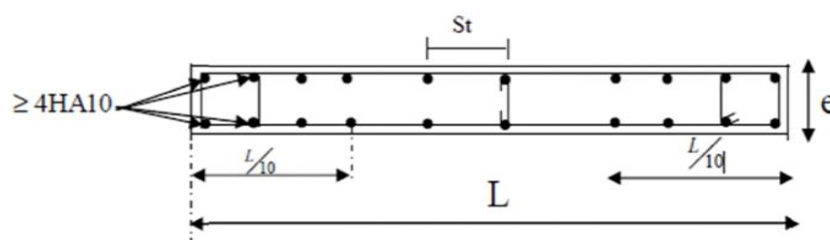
Disposition des armatures verticales dans les voiles.
